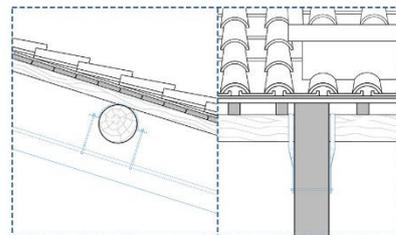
I dettagli rappresentano gli interventi per risolvere i punti deboli delle connessioni degli elementi del tetto tra di loro e con il muro. [estratto Tav. 5]
